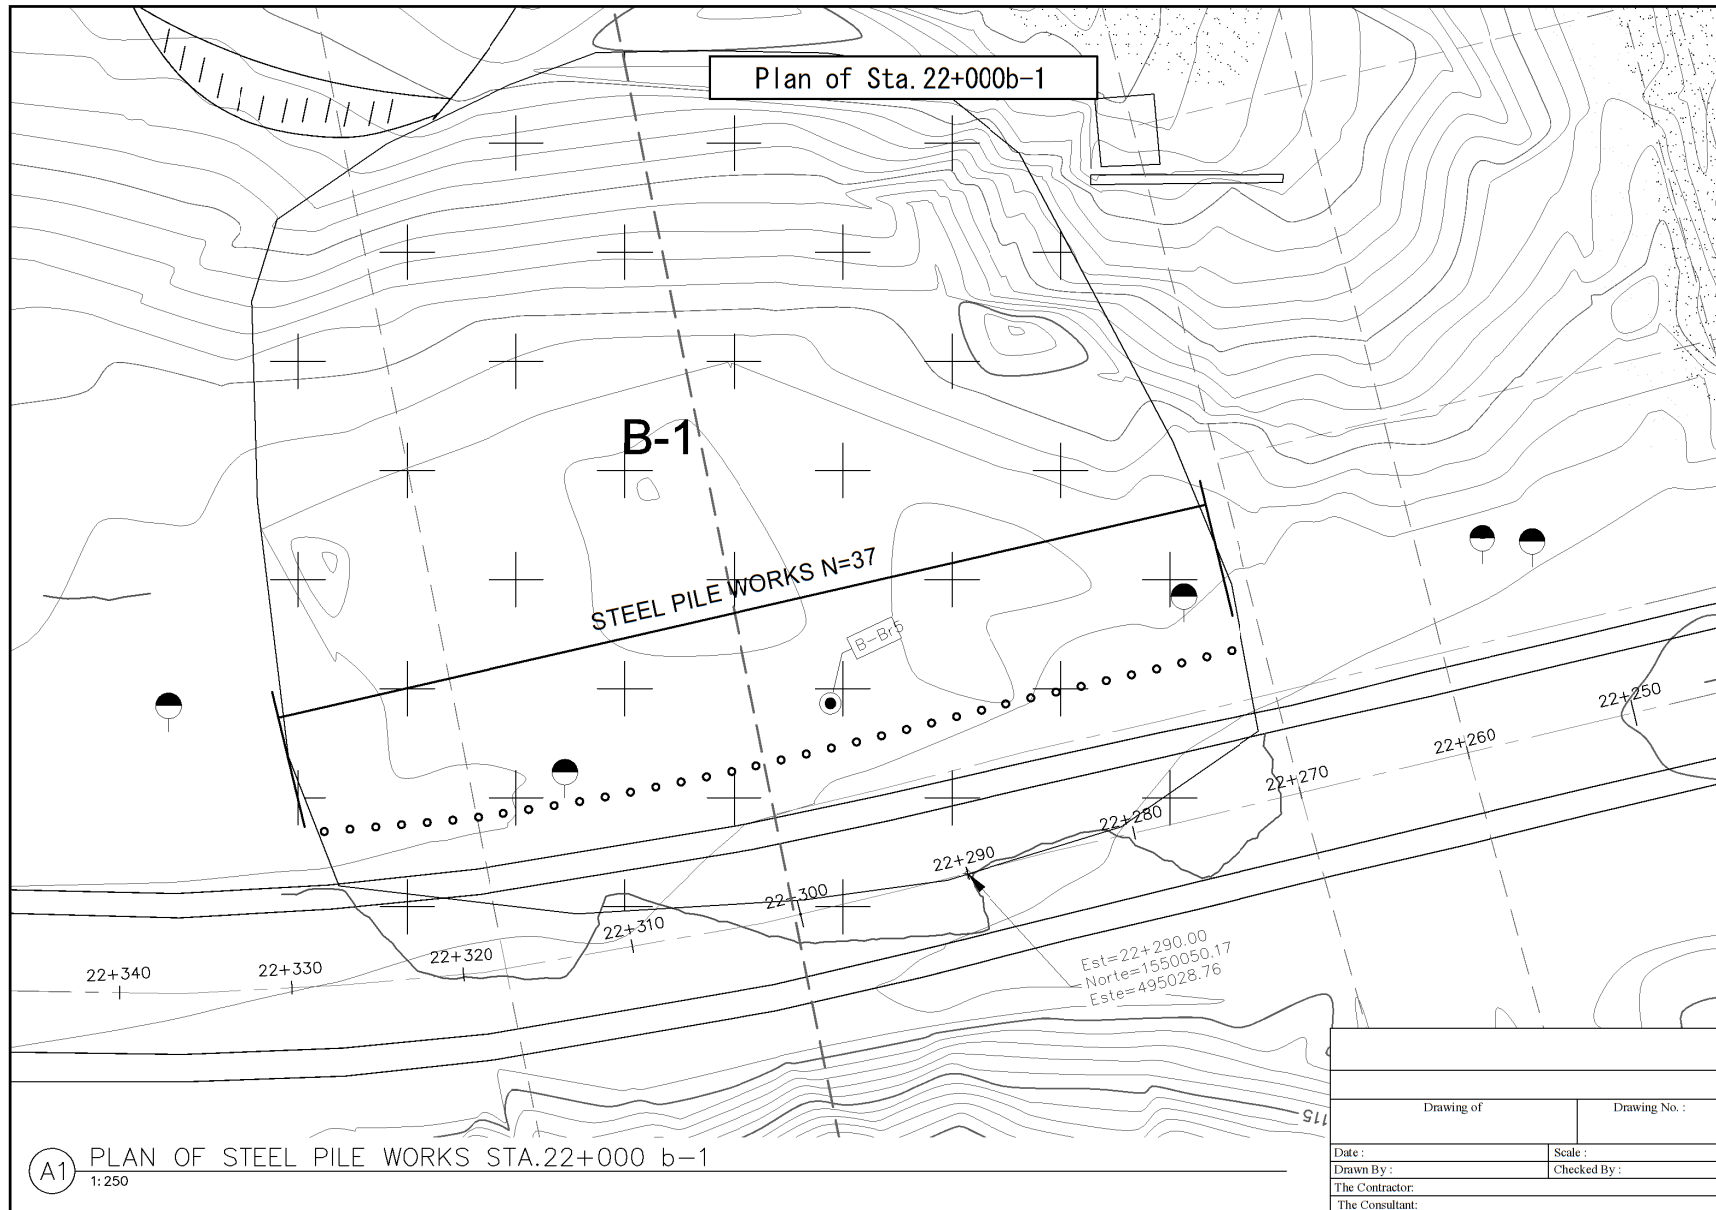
Sta.22 b-1 Vista de plano (Sin escala)
